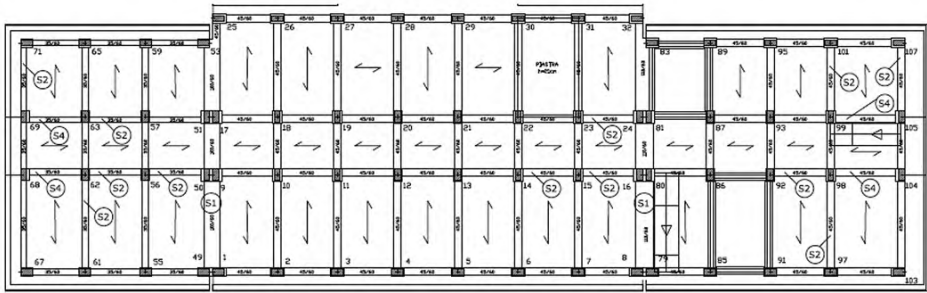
Pianta dell'edificio nello stato di fatto
